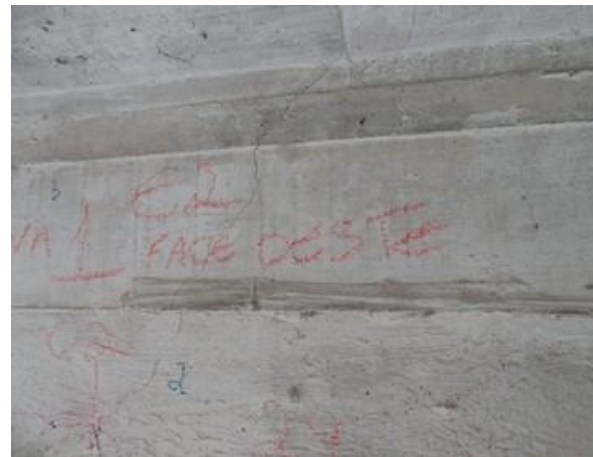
Viga Longarina 1 – Abertura de fissura igual a 0,3 mm.
